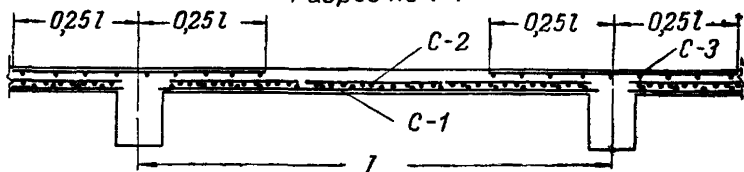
Армирование плит, опертых по контуру узкими сварными сетками с продольной рабочей арматурой (сетки примыкающих панелей плиты на плане условно не показаны)
